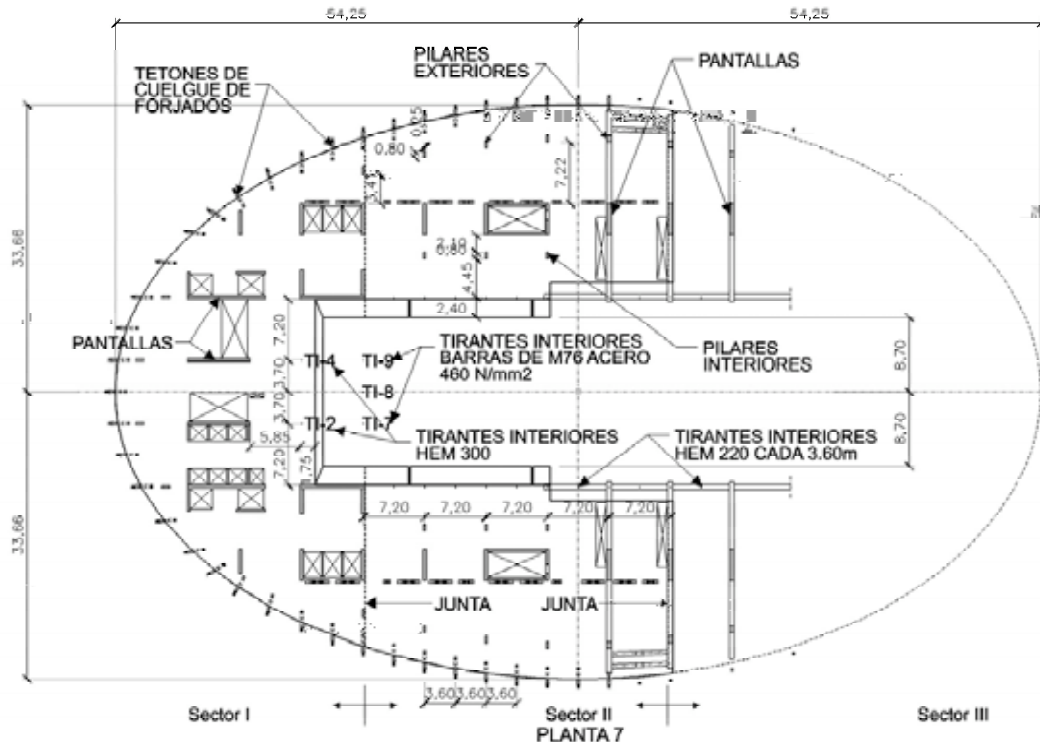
Planta 7. Forjado elíptico de semieje mayor 54,25 m y 33,66 m de semieje menor.
